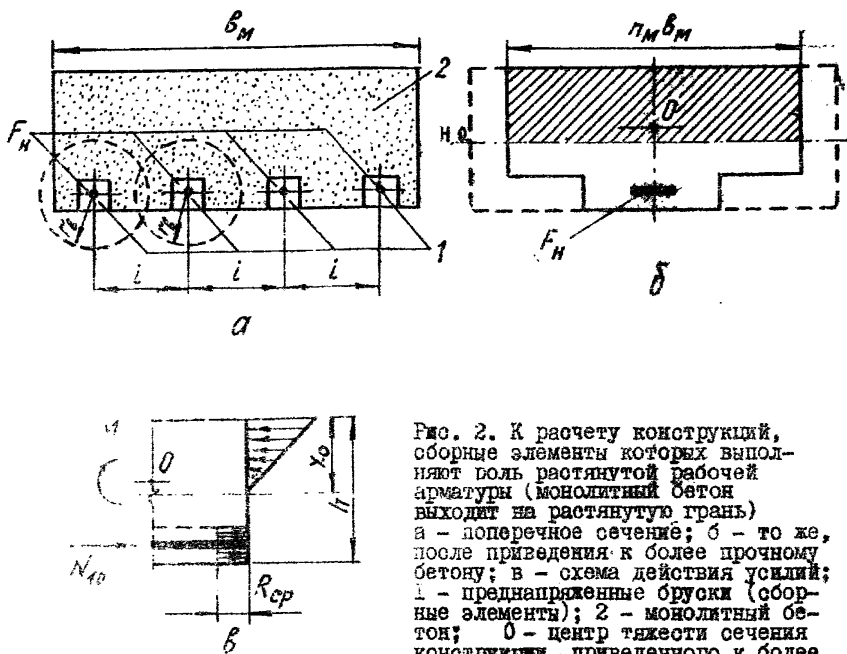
К расчету конструкций, сборные элементы которых выполняют роль растянутой рабочей арматуры (монолитный бетон выходит на растянутую грань) а - поперечное сечение; б - то же, после приведения к более прочному бетону; в - схема действия усилий; 1 - преднапряженные бруски (сборные элементы); 2 - монолитный бетон;  $O$  - центр тяжести сечения конструкции, приведенного к более прочному бетону
